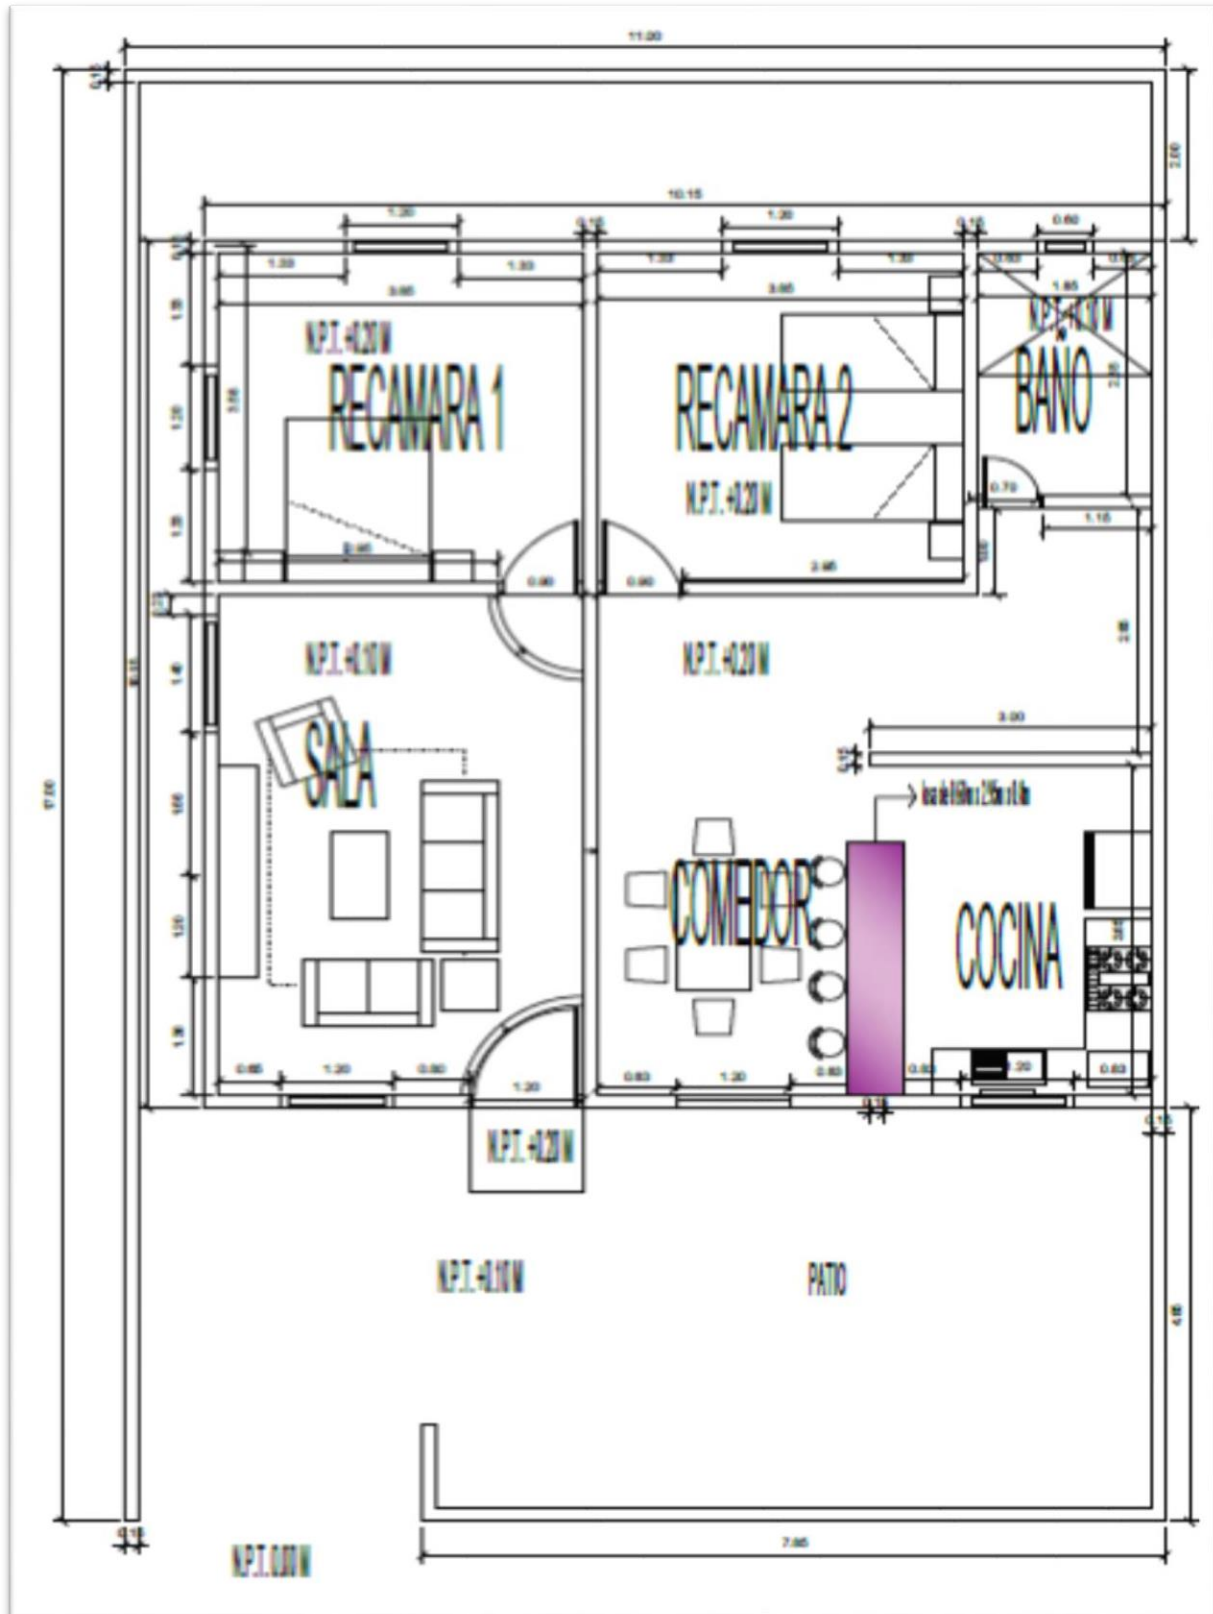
, Distribución en planta de la vivienda (ver anexos para plano completo).
